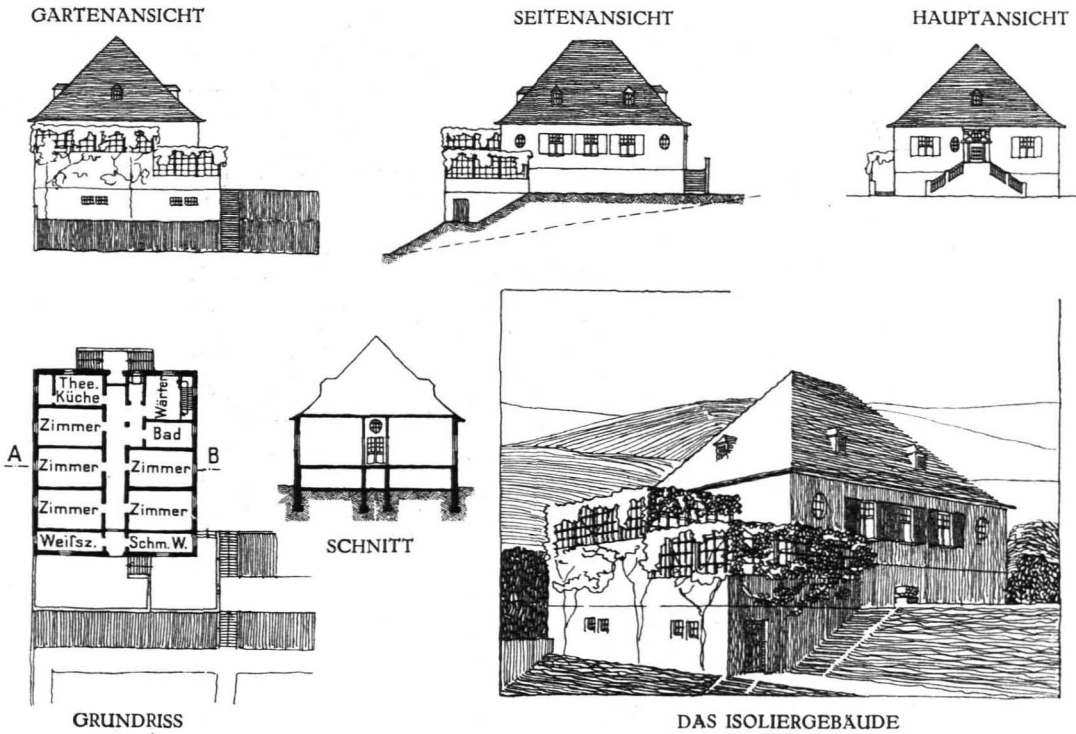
ANSICHTEN UND GRUNDRISS.
